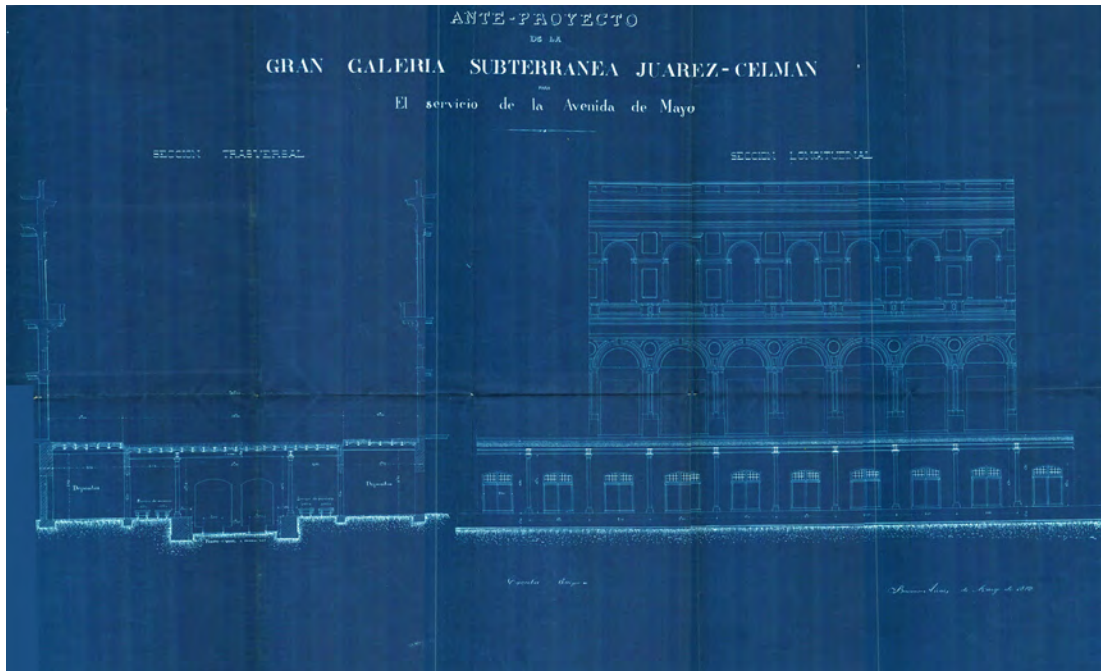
Detalle en corte de las estaciones de la Gran Galería subterránea bajo la Avenida De Mayo propuesta por E. Meincke (1889). Archivo HCDN.
